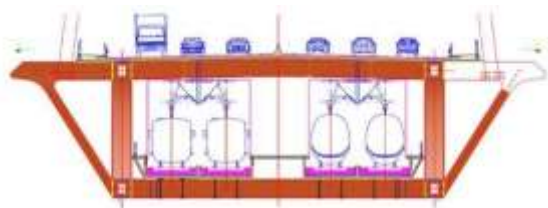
Perfil transversal tipo (secção na zona atirantada) da versão rodo-ferroviária da Ponte Chelas-Barreiro (fonte: RAVE/GRID)
